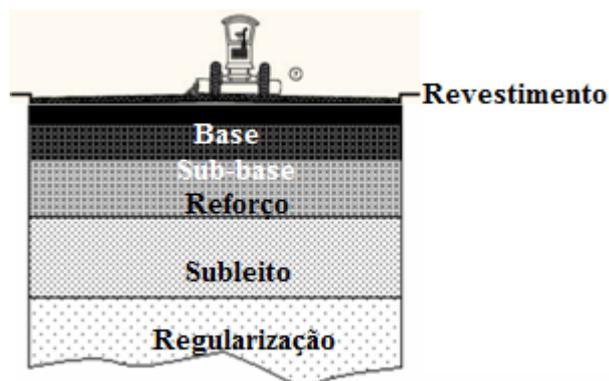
Seção das camadas de pavimento, normalmente construídas, na pavimentação asfáltica (modificado de Brodani e Pinho, 2011).
